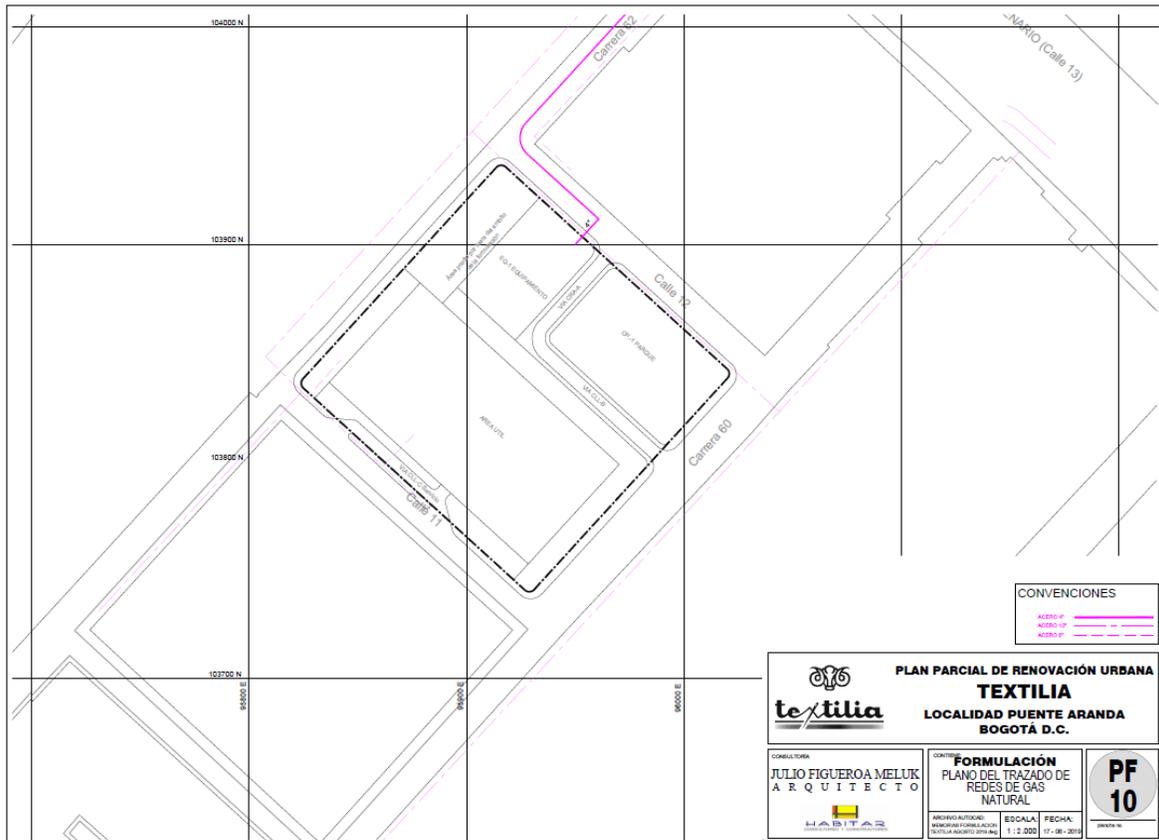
Plano PF-10 Trazado de Redes de Gas Natural
